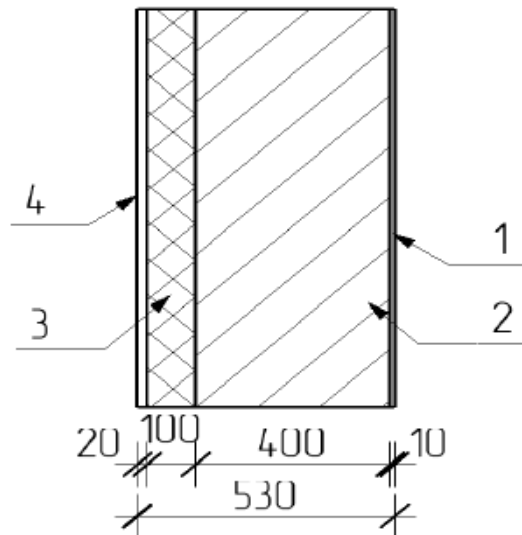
Стіна з утеплювачем, де: 1 – полімер-піщана штукатурка; 2 – бетонний блок; 3 – листи з жорсткої мінеральної вати; 4 полімер-піщана штукатурка.
